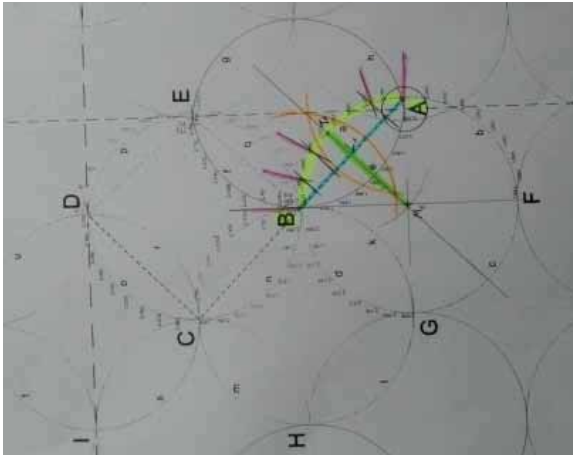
Auf einem Segment der Grundrissfigur (gelb) werden die Rippen bezüglich Fugenteilung (rot) geteilt. Danach werden bezogen auf die Lage des Prinzipalbogens im Grundriss (hellblau) jeweils die Fugenteilung mittels Lot (über Prinzipalbogen) auf die Grundrisslage des Prinzipalbogens übertragen
